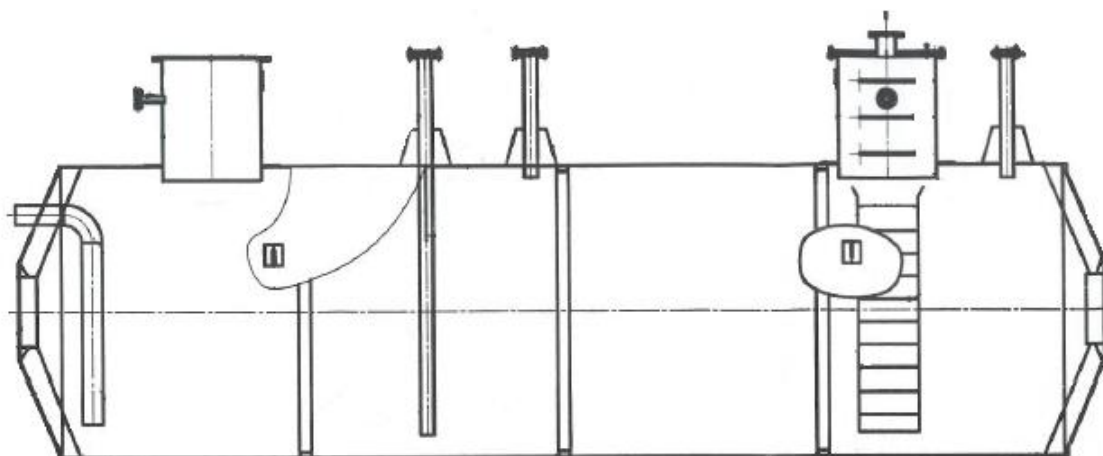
Общий вид эскиза резервуаров РГС-40
